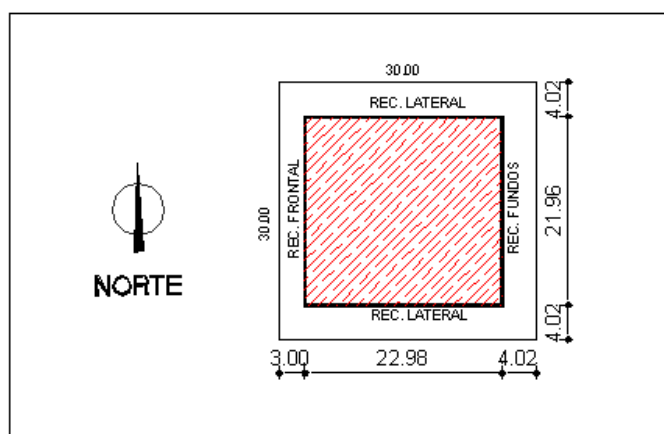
Planta esquemática do bloco padrão, segundo os recuos propostos pela SEMURB.
